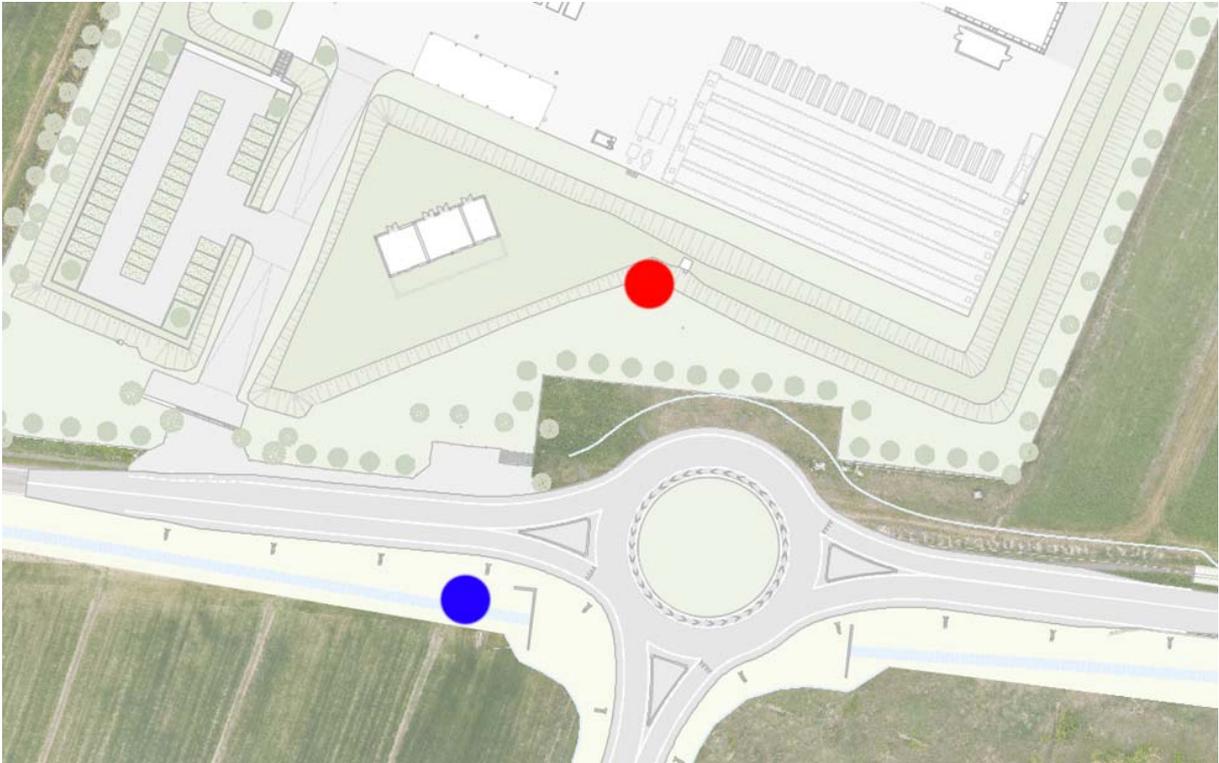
Planimetria con indicazione del pozzetto di disconnessione (in rosso) e scarico nel canale Naviglio Nuovo (in blu)
